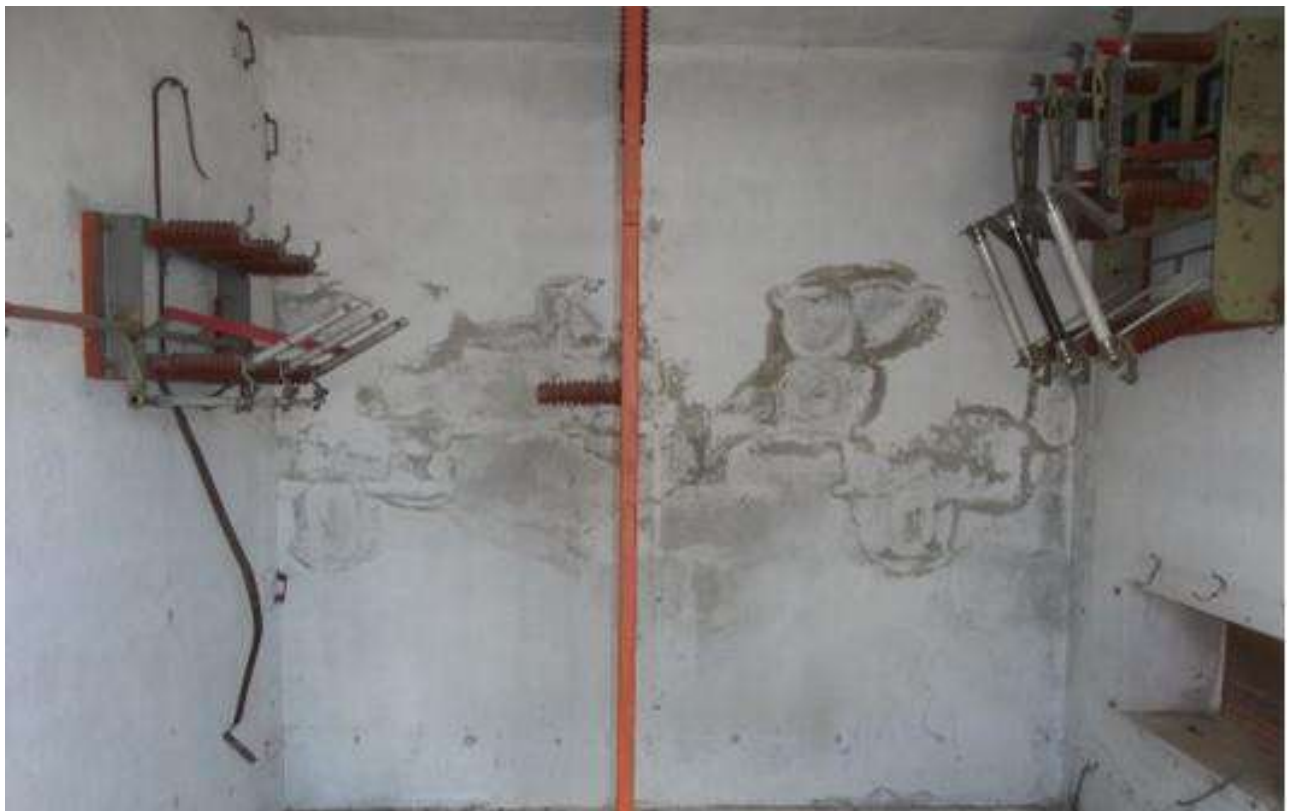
Piano Terra – Quadro Elettrico – sub 2
